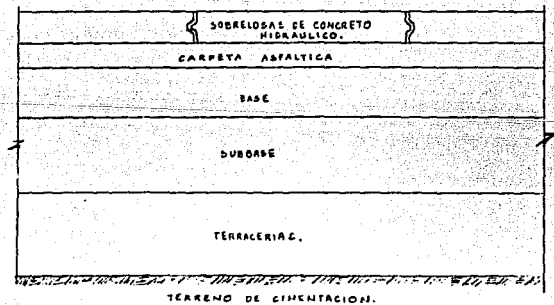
(b). Pavimento flexible reforzado a base de sobrelasas de concreto hidráulico.
